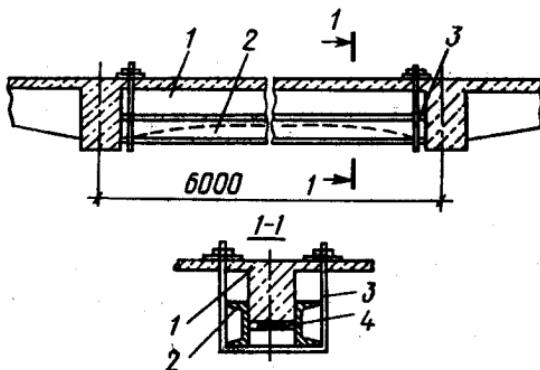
Частичная разгрузка металлическими балками снизу:
